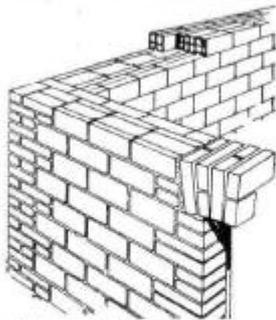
Sezione di murature in « Blocchi S » da 3 teste con applicazione di rivestimento esterno in COTTOANTICO. Sulle aperture, architravi SAPAL.
